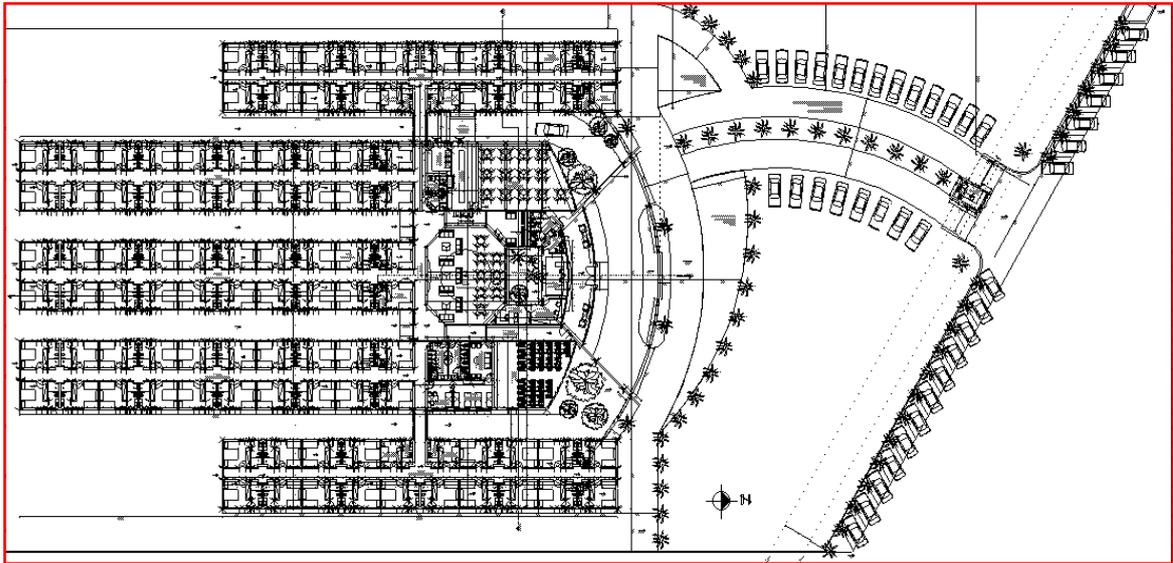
Planta Baixa. Fonte: (Rosa/2011).
